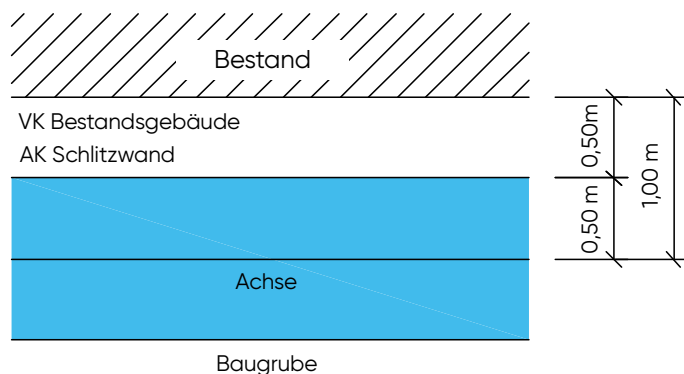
Abstand Achse SLW zur Außenkante Bestand.
